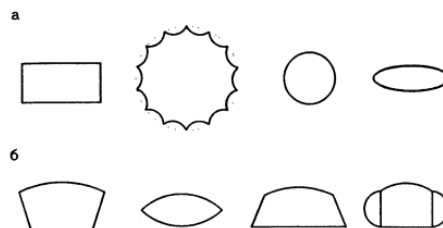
Конструктивные формы резервуаров: а – формы резервуаров в плане, б – варианты стен
